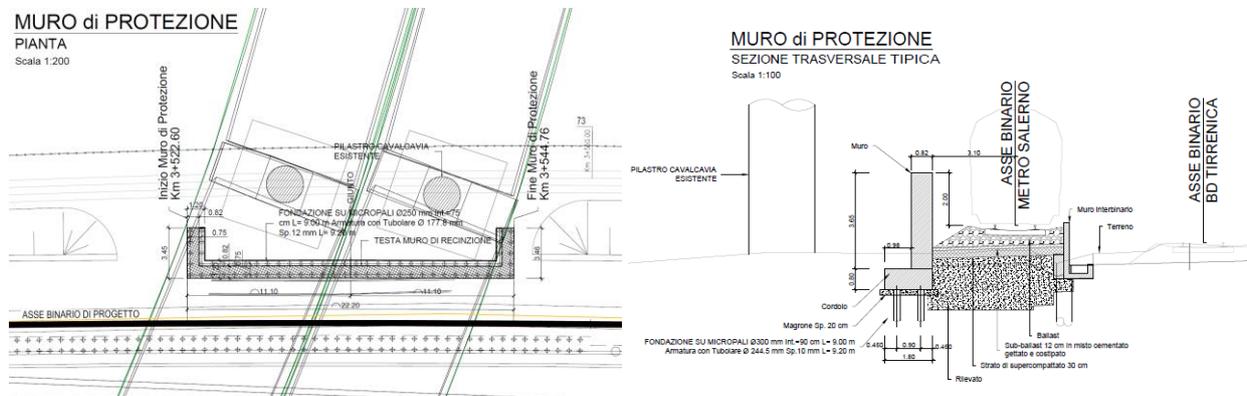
Opera di protezione cavalcaferrovia pk 3+530 (pianta e sezione)
